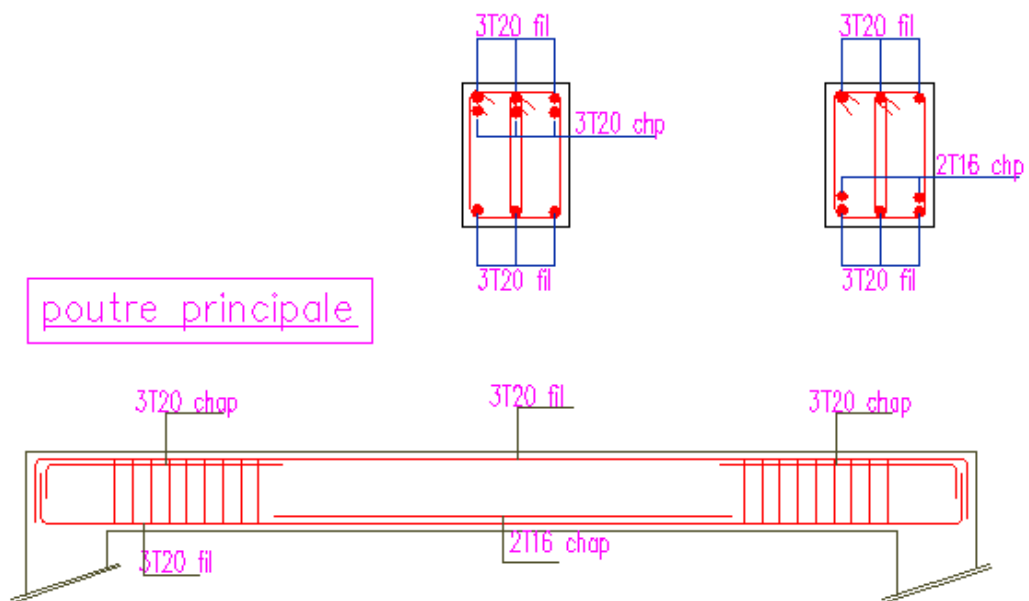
Ferrailage d'une poutre principale de la soupenite
